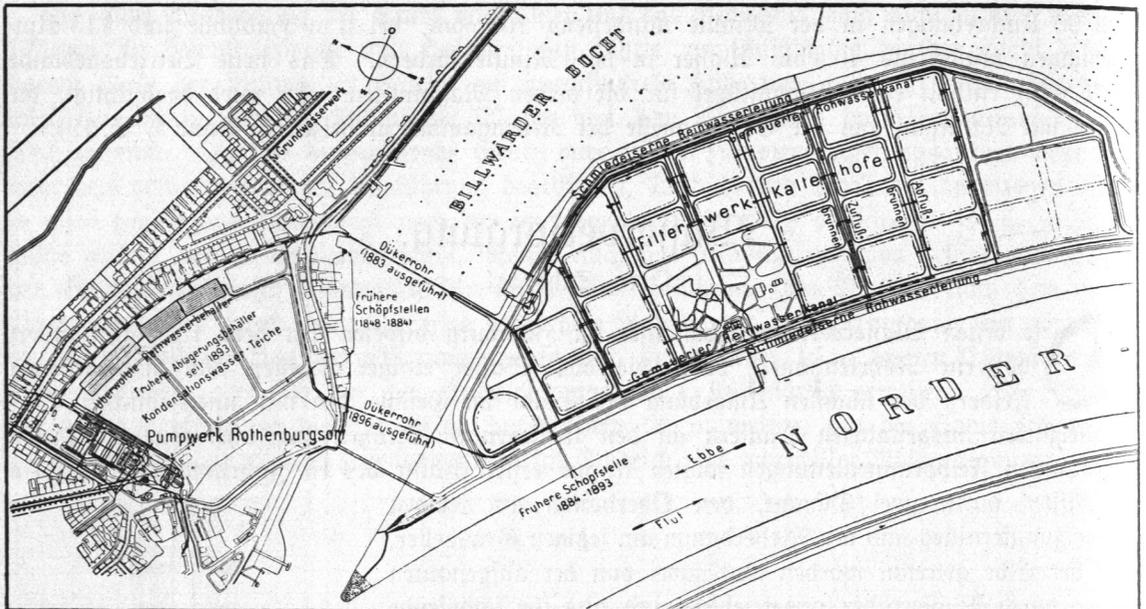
Pumpwerk Rothenburgsort und Elbwasserfilterwerk, Lageplan.
